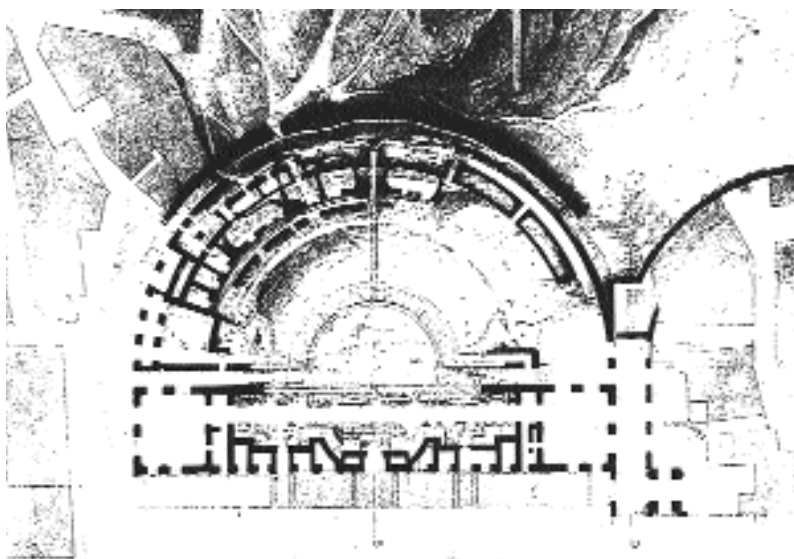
Plan du théâtre d'Orange. L'escalier central de la *cavea* tel que l'a reconstitué P. RENAUX vers 1840. (Arch. Patrimoine.)
